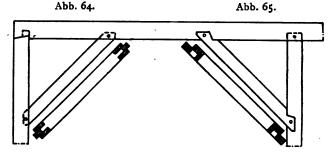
u. 65. Verbindung der Längsbüge mit den Pfosten und der Pfette.
